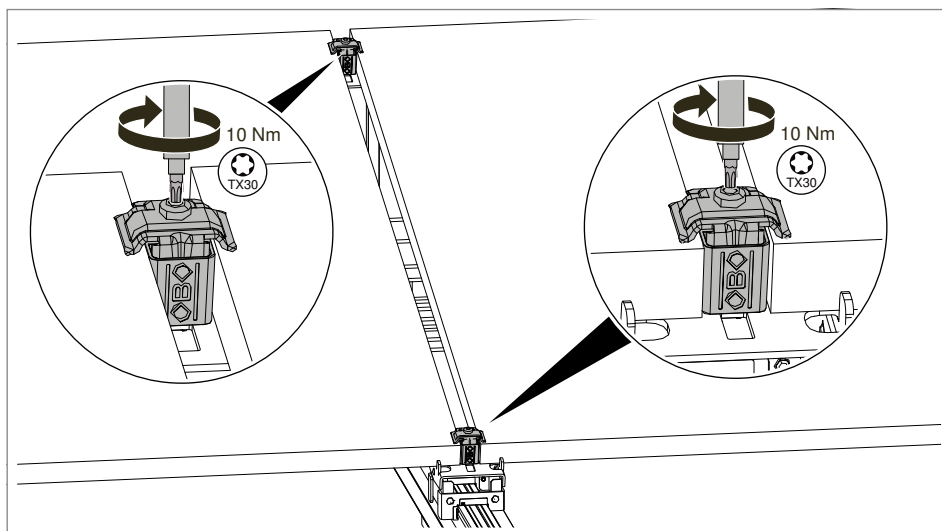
PV-Module mittig mit Universalklemmen befestigen
